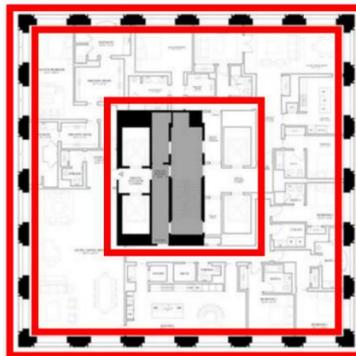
Plantas pavimentos tipos edifício Park Avenue 432. / Figura 53 - Plantas pavimentos tipos edifício Park Avenue 432
